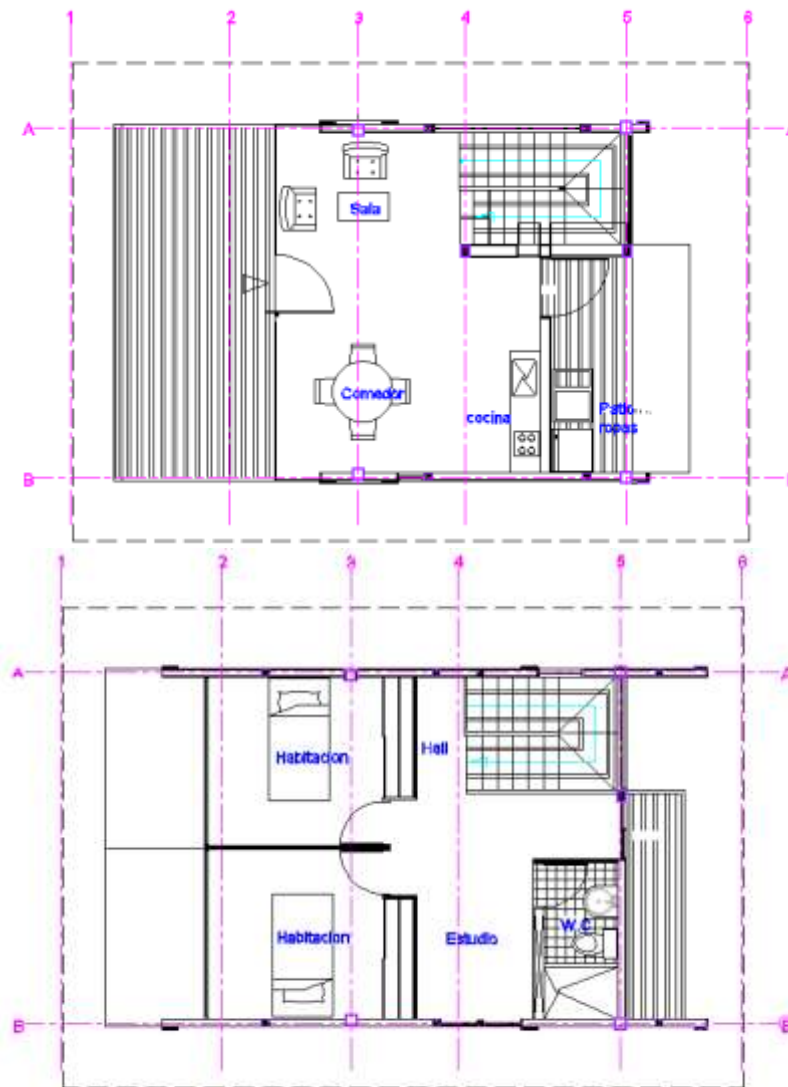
Arquitectura plantas de piso 1 y 2 de vivienda en guadua laminada
